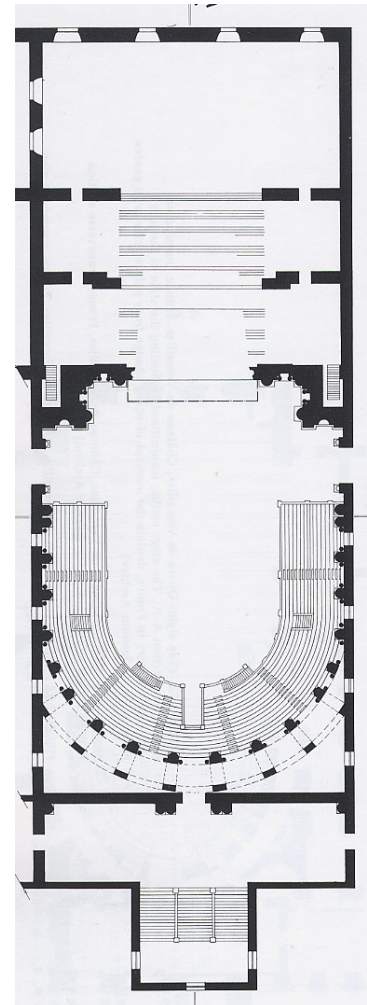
Pianta del Teatro Farnese, 1618, di G. Aleotti.
